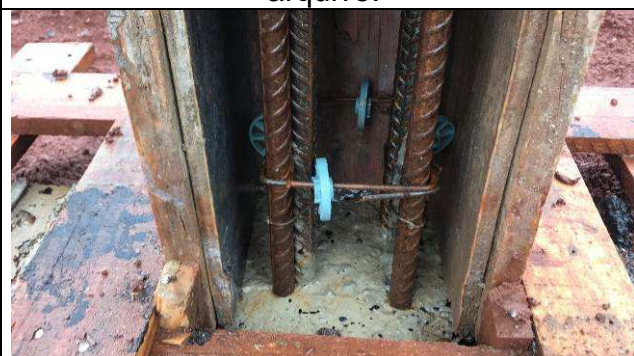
C: Formas e armaduras do pilar P49 do prédio principal.
